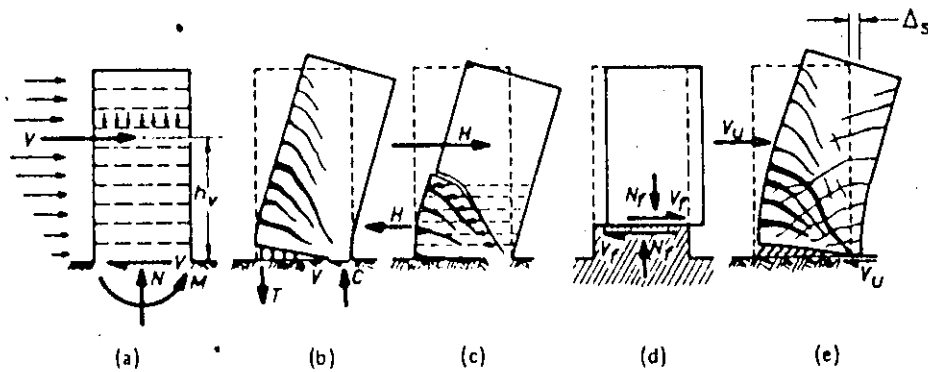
Modos de falla en un muro de cortante en voladizo, de concreto reforzado, cargado lateralmente.
